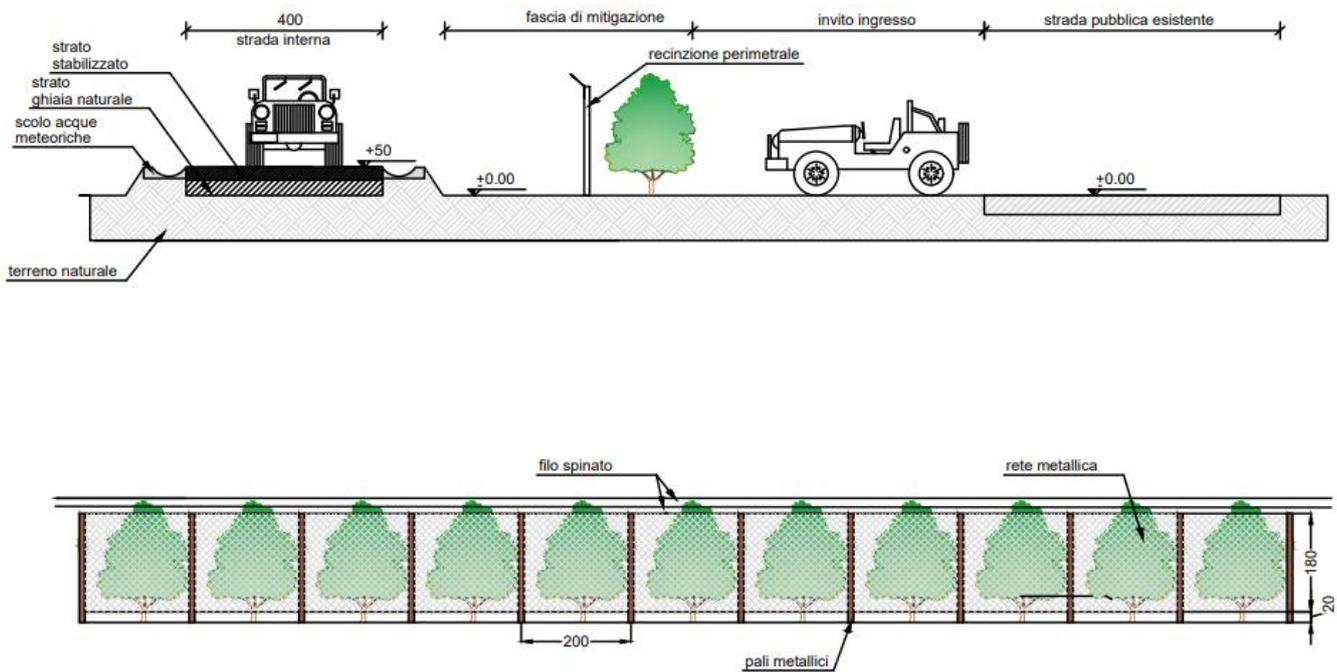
Dettagli della fascia di mitigazione prevista dal progetto
